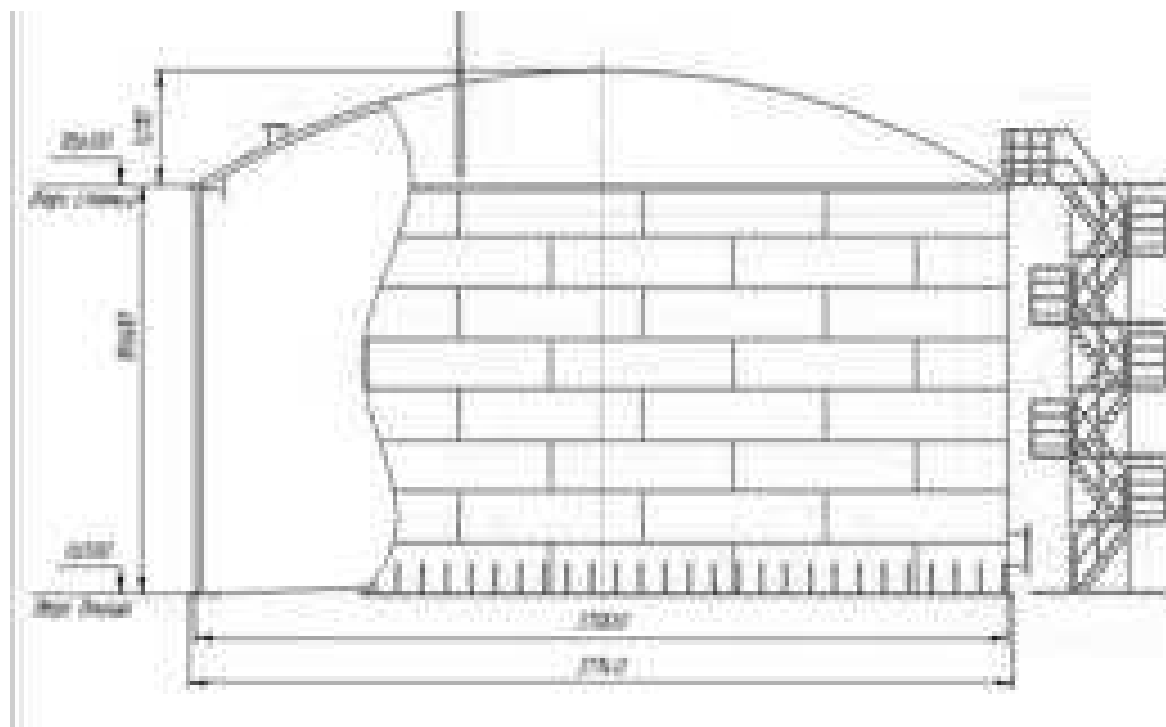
Общий вид резервуара с шахтной лестницей
